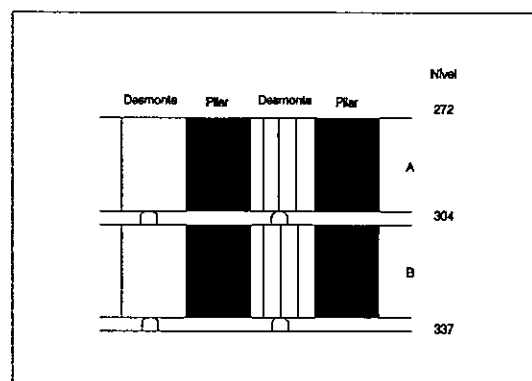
Ilustração do método de desmonte "long wall" - secção transversal do jazigo.
